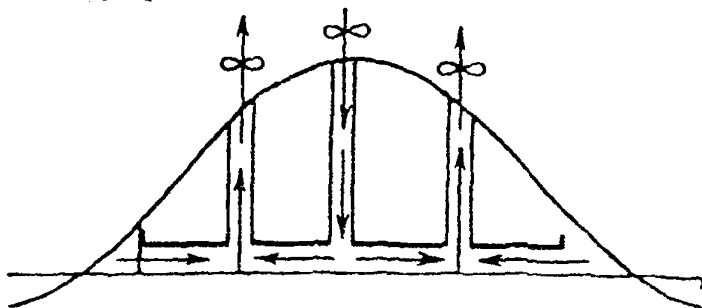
Схема продольной вентиляции тоннеля через шахтные стволы
